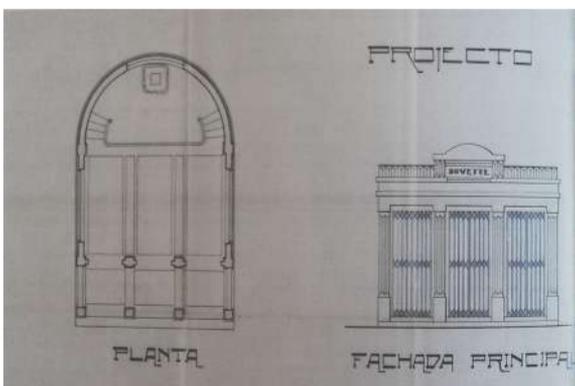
| Planta e Fachada Principal do pavilhão da Fonte de Vale da Mó projetado pelo engenheiro António Rodrigues (1932)
